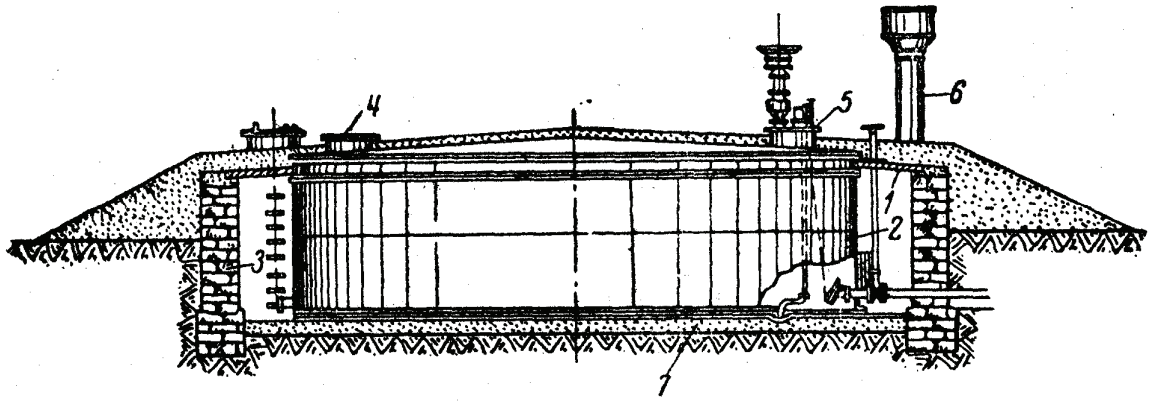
Общий вид резервуара заглубленного со стенкой типа «каземат»
